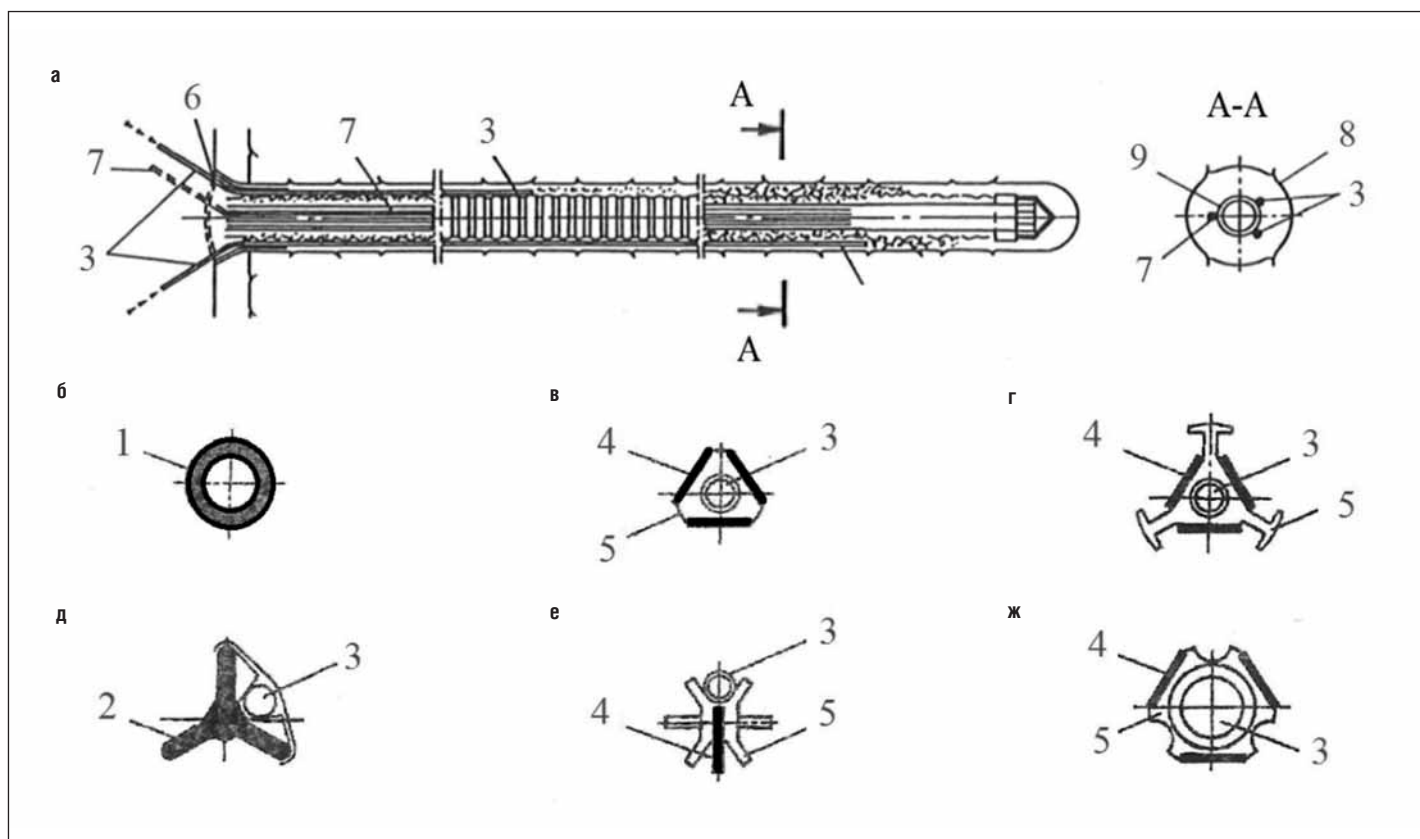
Конструкция армирующих фибергласовых элементов: а – продольный разрез с поперечным сечением; б–ж – варианты поперечных сечений; 1 – трубчатый элемент; 2 – Y-образный элемент; 3 – трубка для инъектирования; 4 – плоский элемент; 5 – кондуктор; 6 – пробка из расширяющегося пластического материала; 7 – трубка для отвода воздуха; 8 – скважина; 9 – фибергласовая трубка
